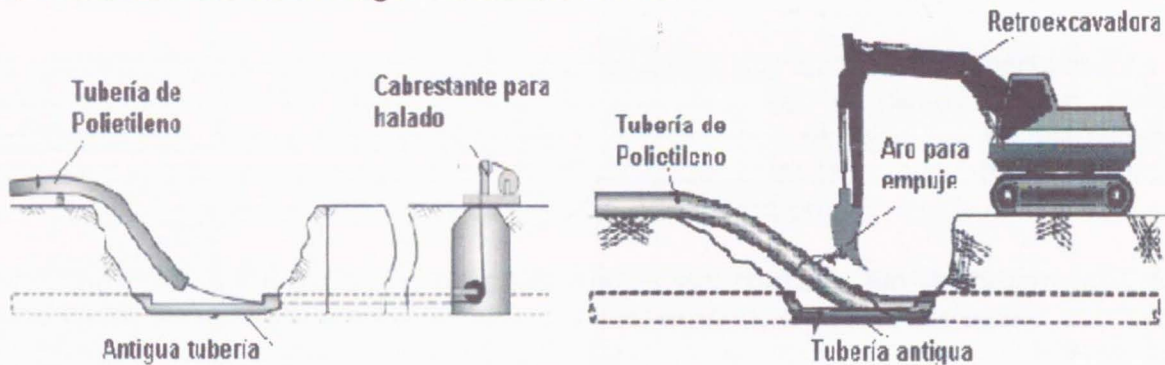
Técnica de halado para el deslizamiento de tubería (izquierda) y técnica de empuje (derecha)⁵
